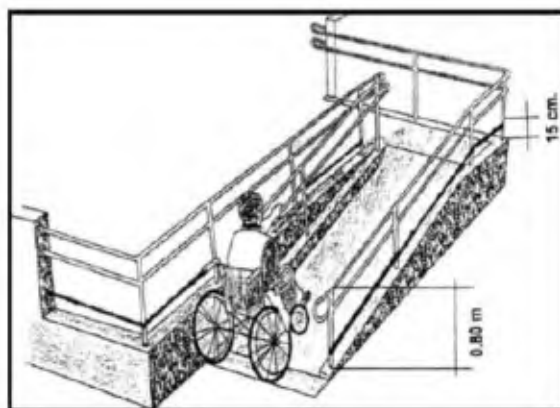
Altura de pasamanos rampa (Fuente: CONADIS)
